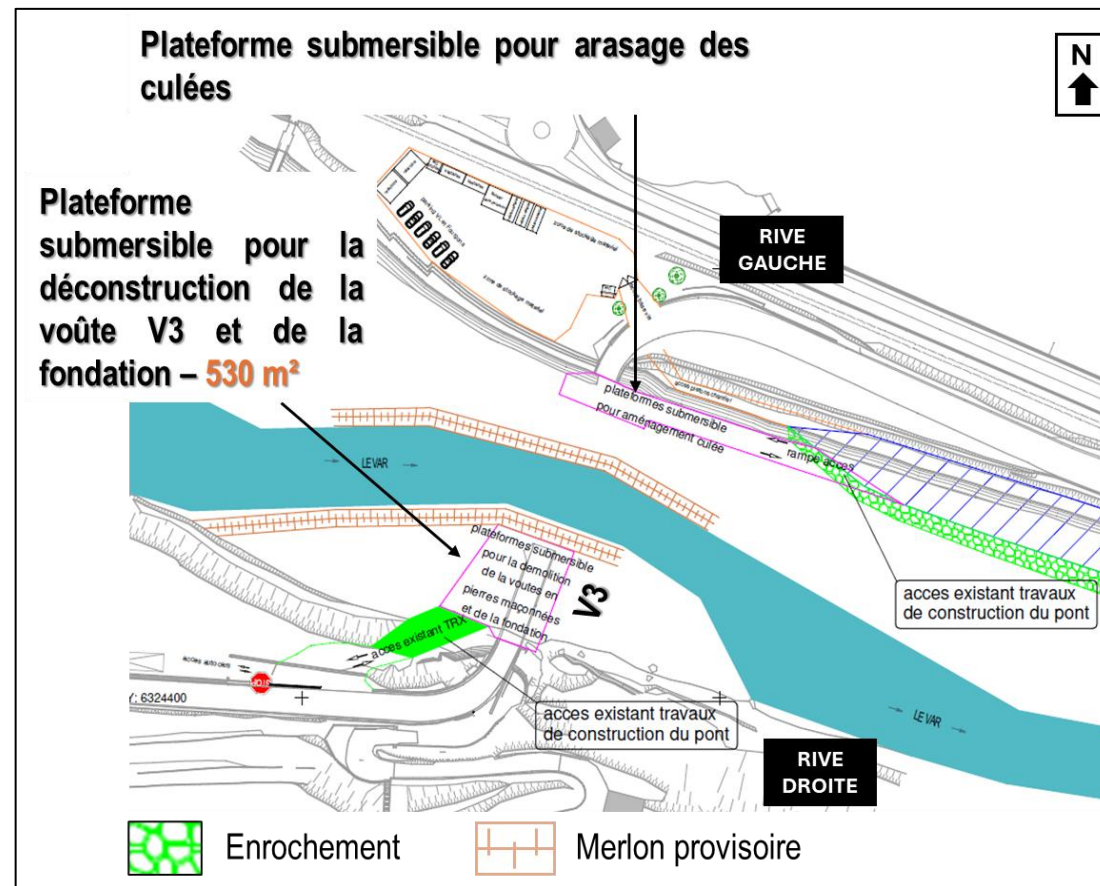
Installations de chantier en rive gauche et droite pour la déconstruction du pont existant
